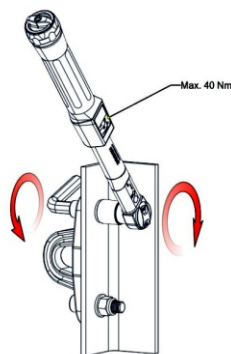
Modalità di serraggio del punto di ancoraggio alla struttura in acciaio mediante l'utilizzo di una chiave dinamometrica
